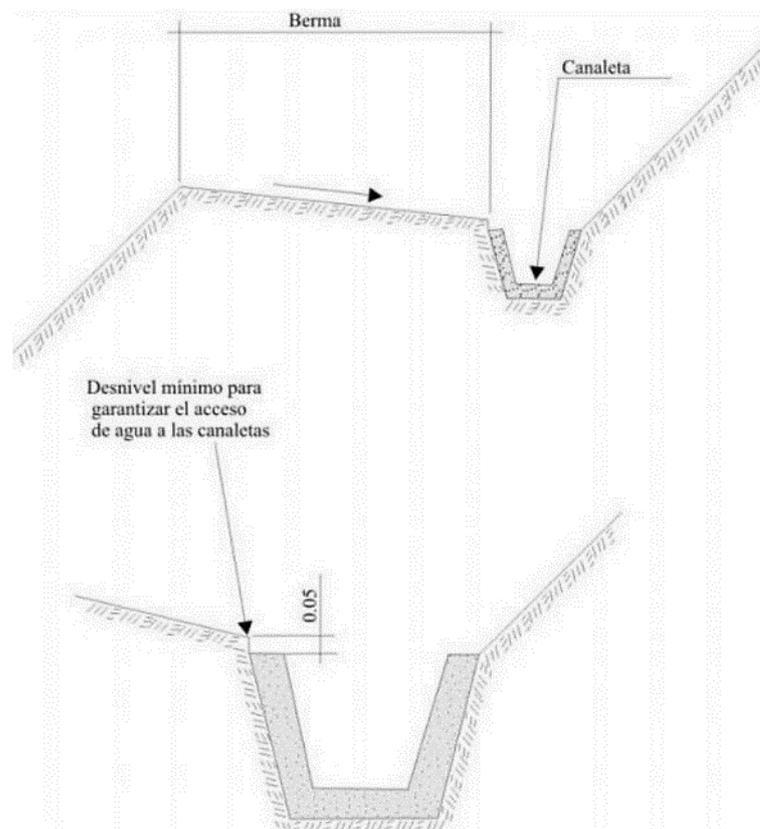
Detalle una canaleta de drenaje superficial (zanjas de coronación). Tomado de INGEMMET (2000).
